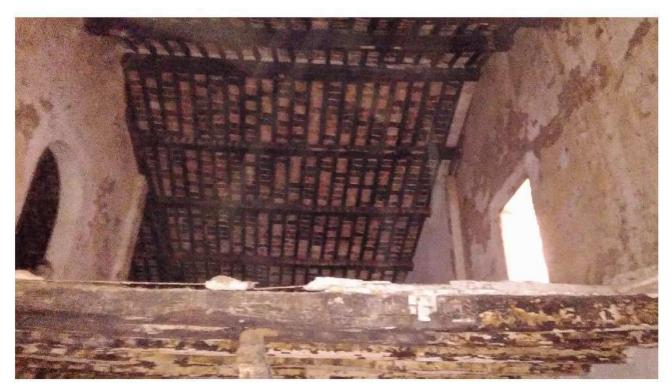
FOTO DAL LOCALE "C" CON VISTA DELLA FALDA SUD DELLA COPERTURA E IN PRIMO PIANO LA TESTA DEL SOLAIO INTERMEDIO
